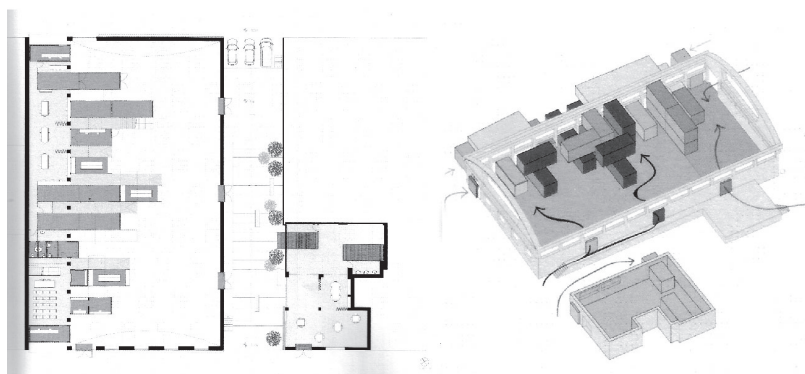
Progetto del Centro di riuso: schema distributivo e pianta [Elaborazione Martina Pappalardo].
